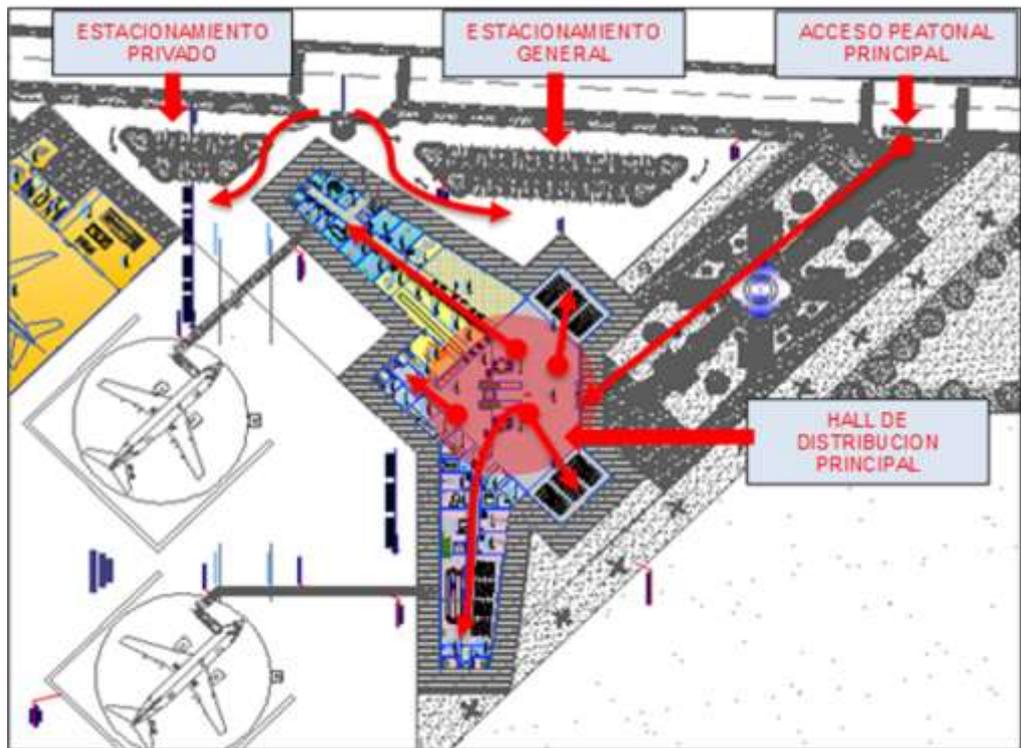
Terminal aéreo lado tierra; fuente Plano Zonificación Módulos A-01
